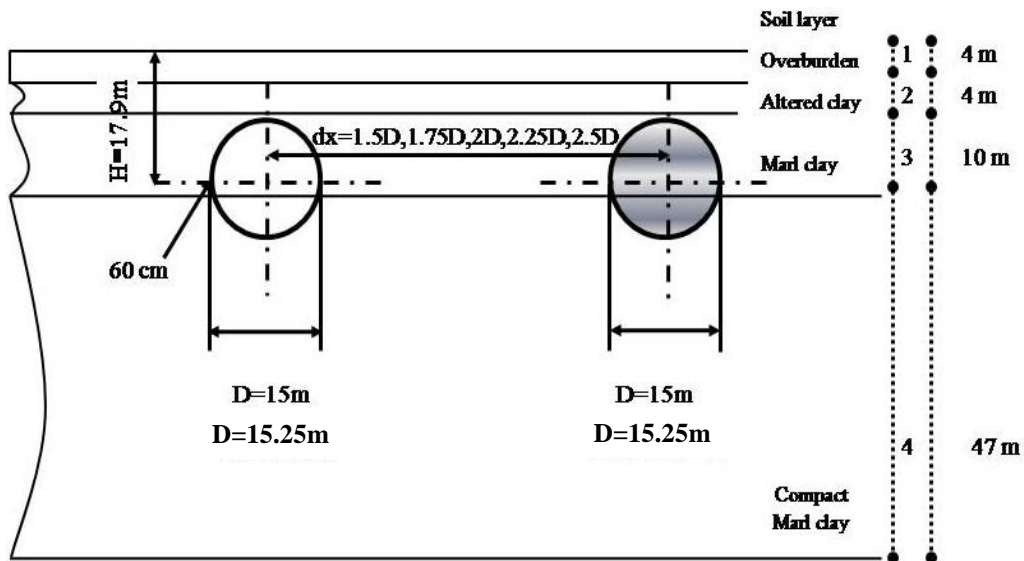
Conditions géologiques et coupe transversale typique des deux tunnels
